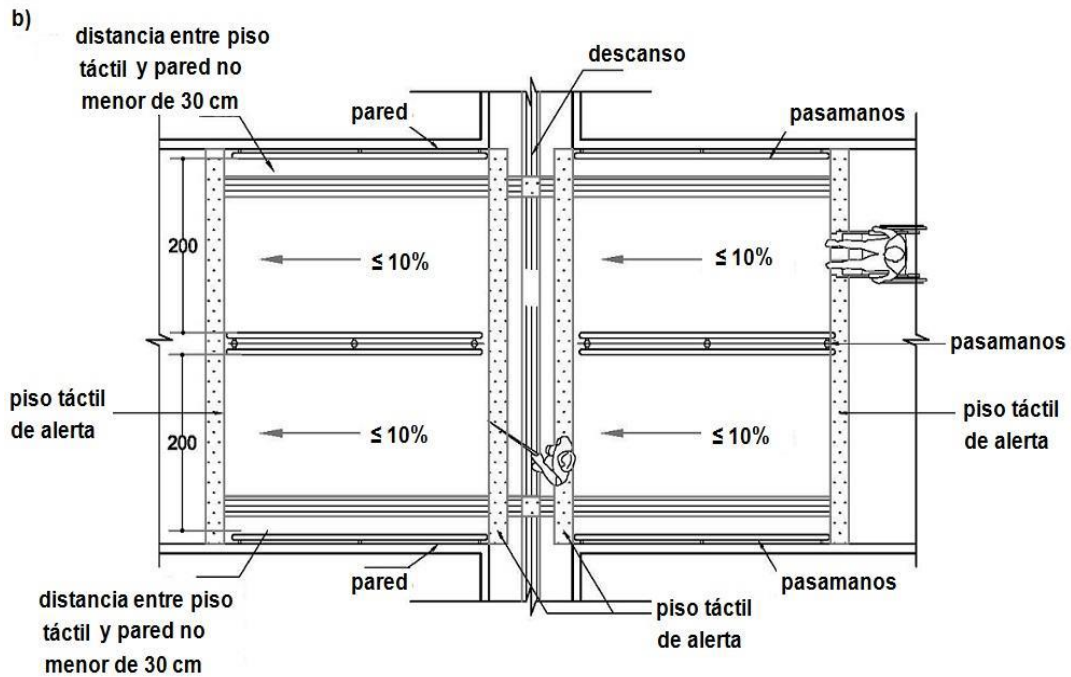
b) Vista en planta de rampa y de pasamanos central en donde se indica el espacio para el cambio de carril en cada descanso
